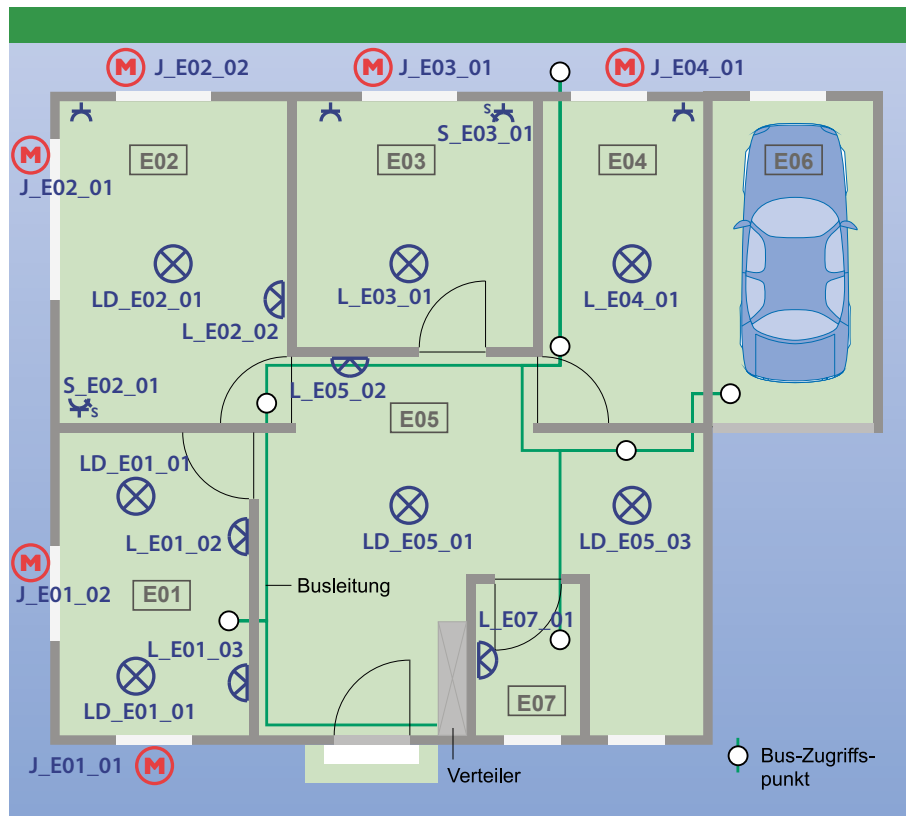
fertig bezeichneter Grundriss (Quelle: KNX Swiss)
